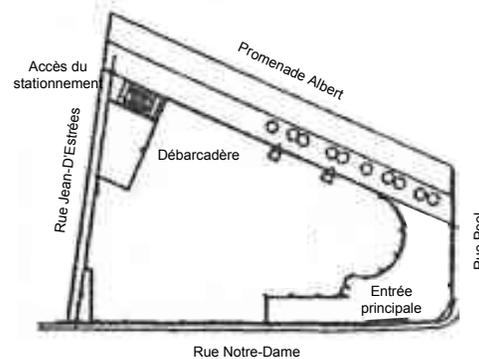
Implantation et alignement d'après l'Annexe B du projet de règlement P-02-218, cartouche « Plan repère » de la planche A-100 (Plan de localisation)
